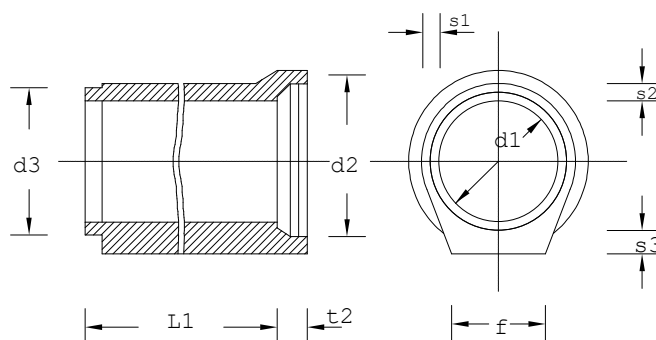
tubi in calcestruzzo di sezione circolare con manicotto e con piede di appoggio
